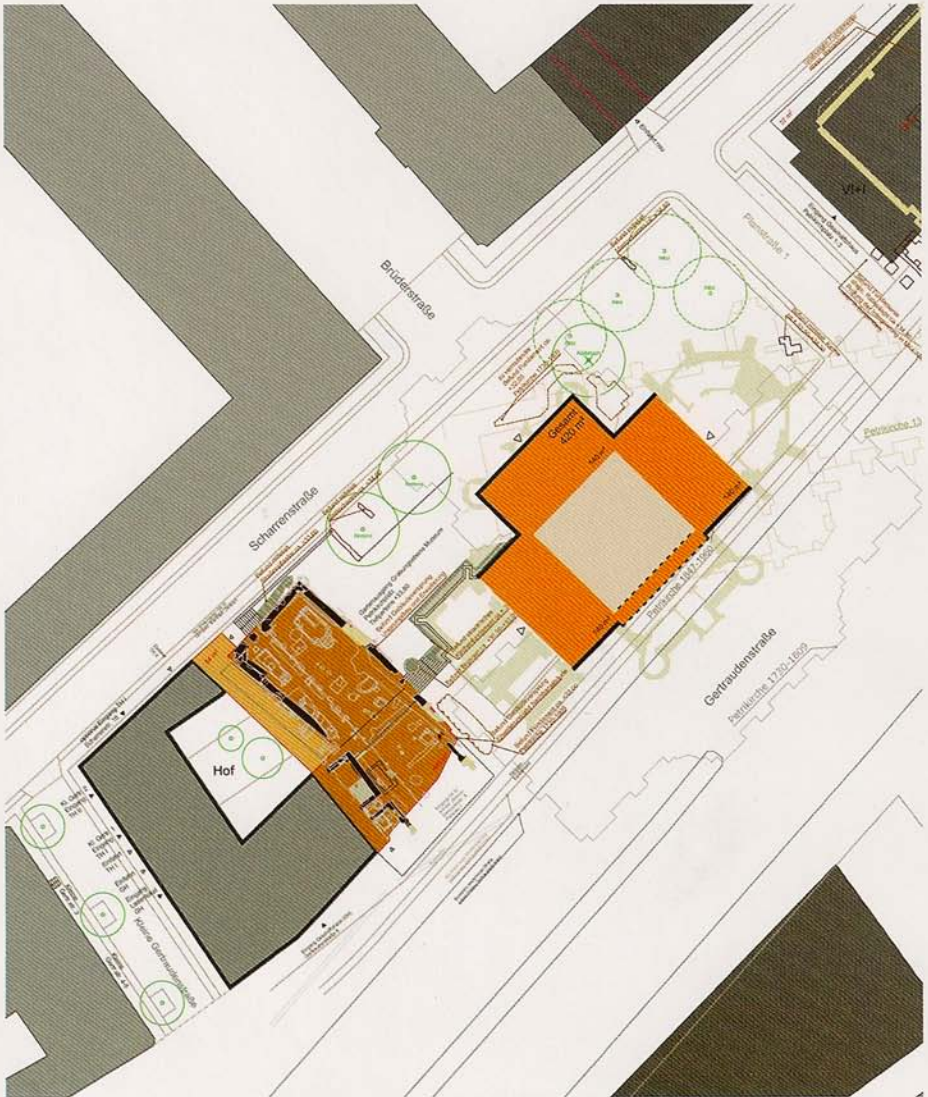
Lageplan Entwurf Petriplatz mit sakralem Gebäude, Stand Mai 2010
